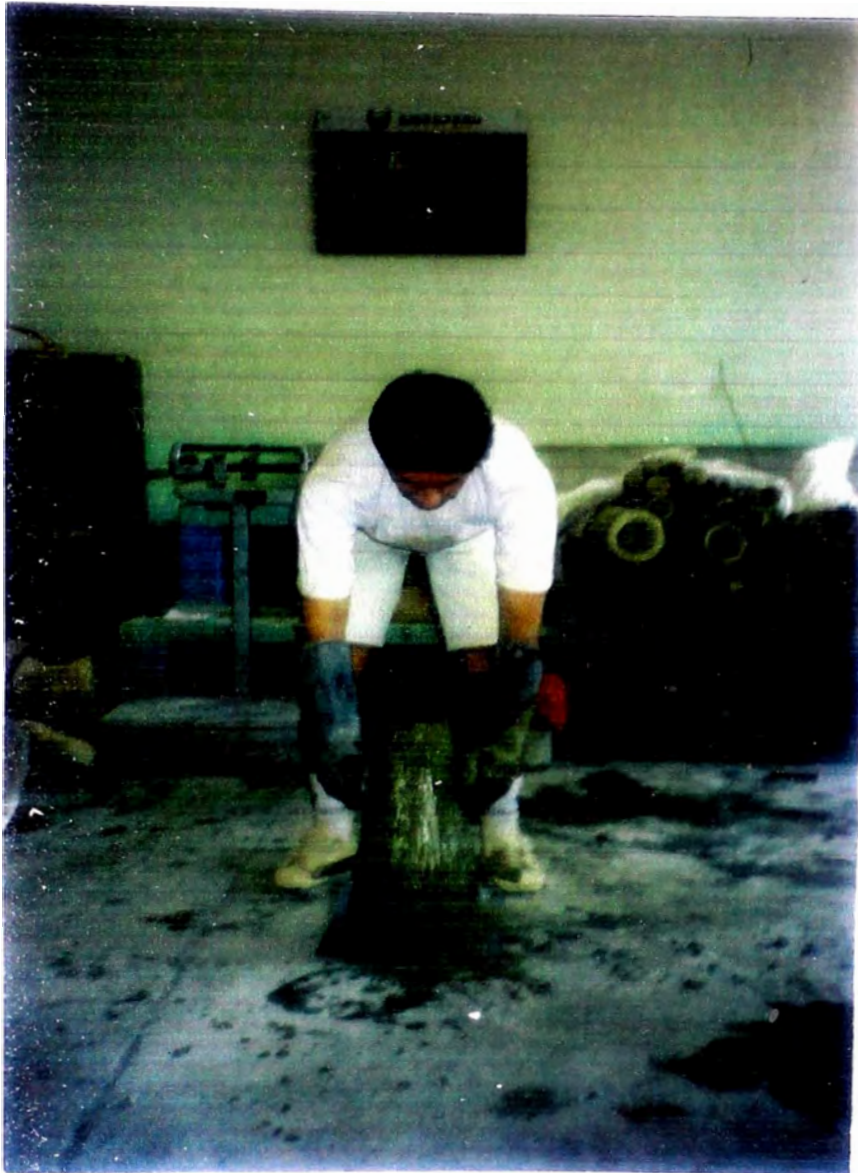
Ensayo de Asentamiento – Cono de Abrams
